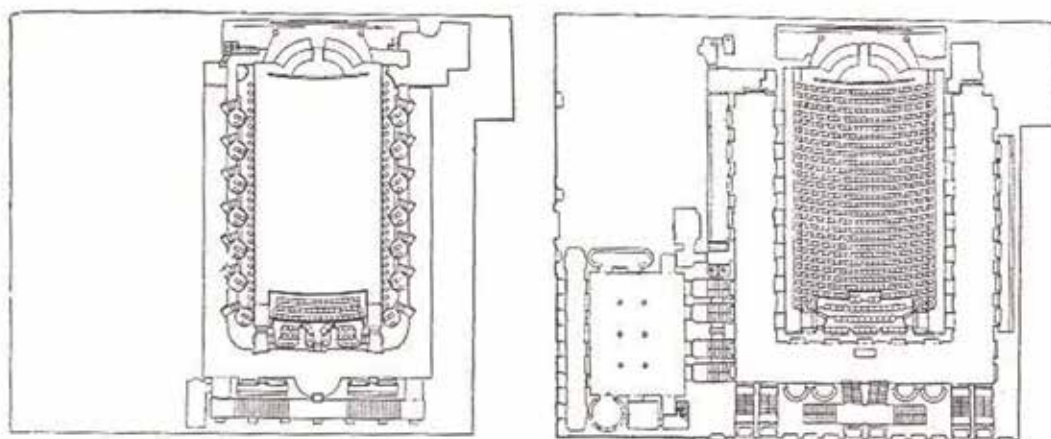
Esempio di pianta rettangolare, Cinema Scandia di Stoccolma, pianta galleria-pianta platea
